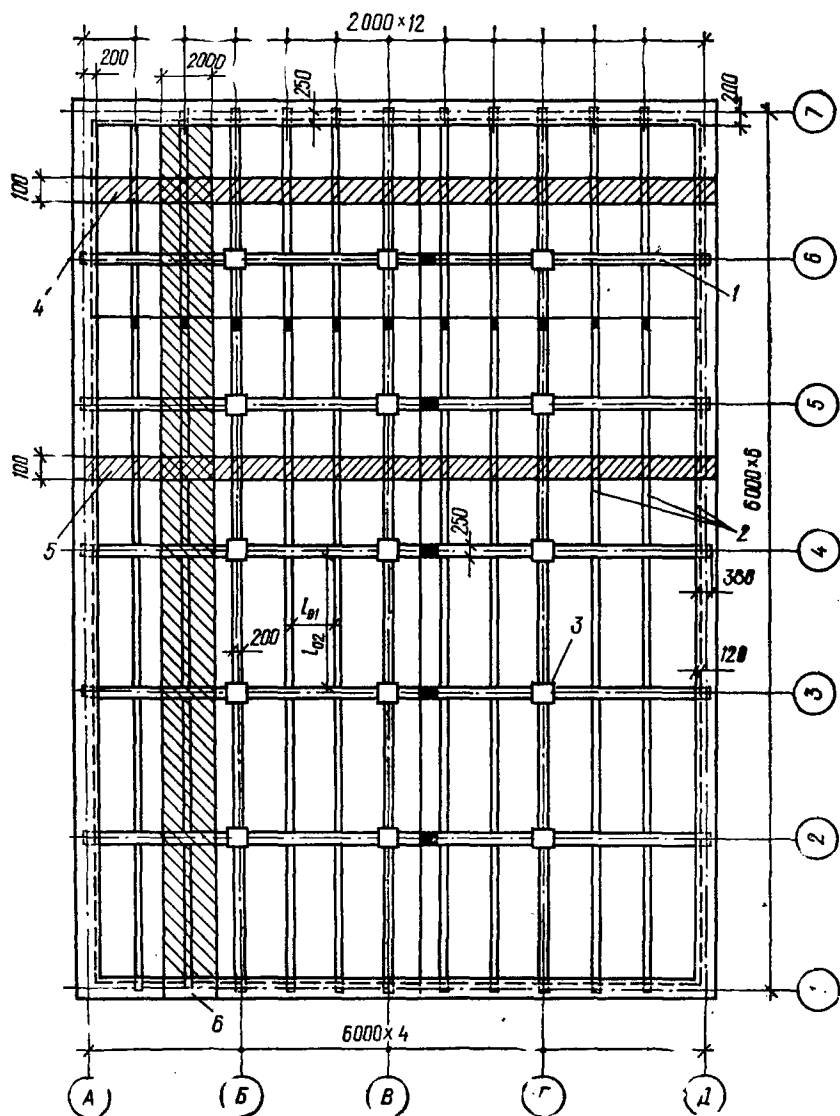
Конструктивная схема монолитного ребристого перекрытия с балочными плитами:
